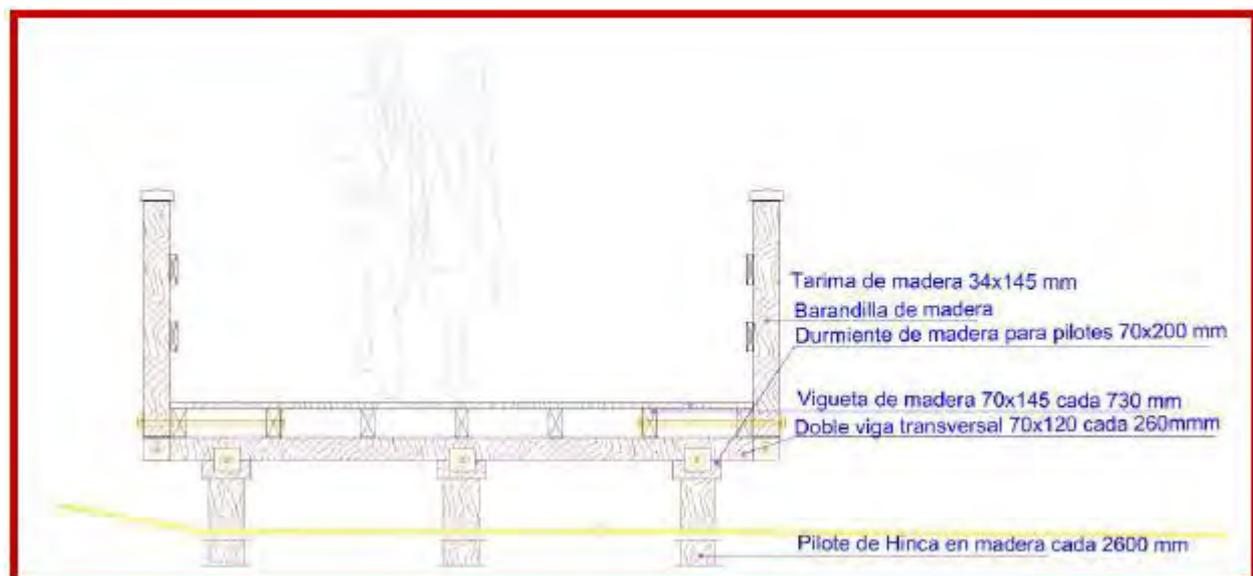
Sección tipo de diseño propuesta en sendero elevado sobre la playa (Fuente: Proyecto básico 2018)
